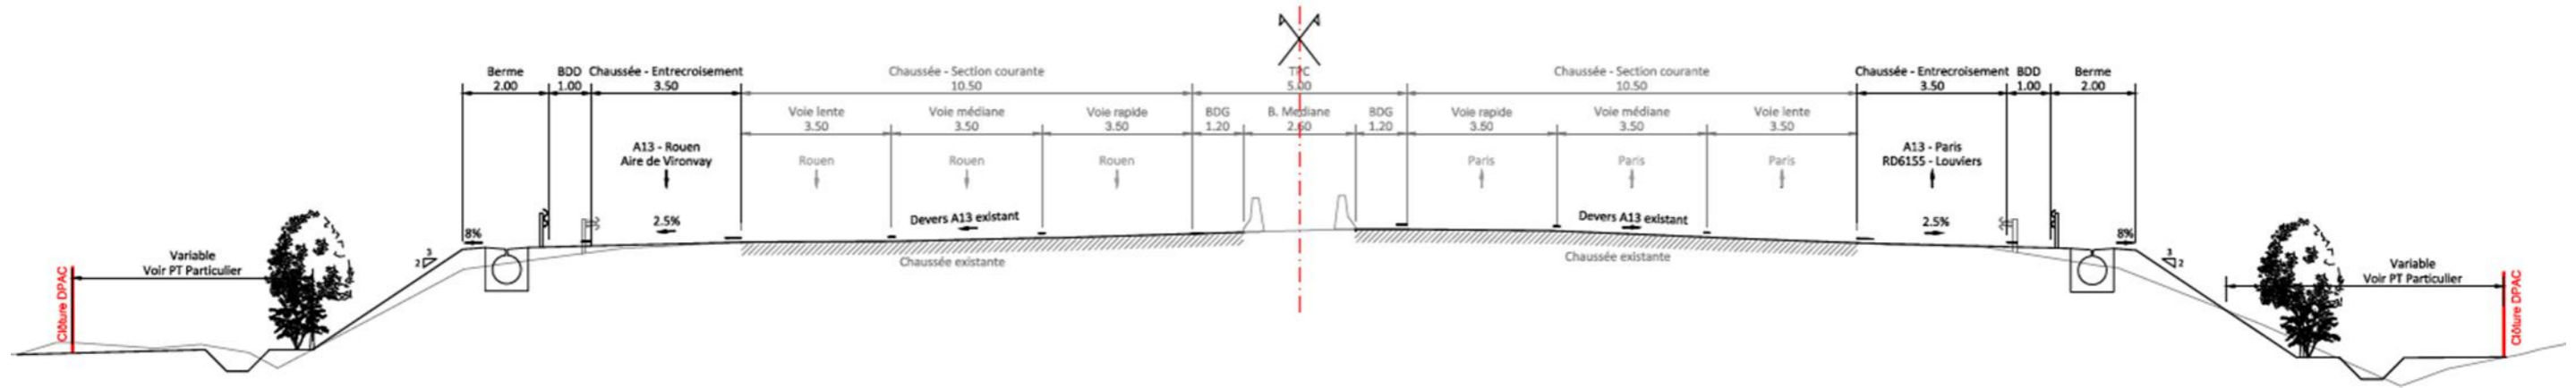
PROFIL EN TRAVERS DE LA SECTION COURANTE AU DROIT DES ENTRECROISEMENTS
